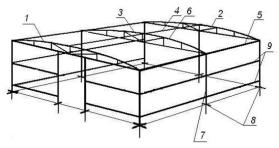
Схема каркаса группового сетчатого изолятора: 1 — ферма торцевая передняя; 2 — ферма торцевая задняя; 3 — ферма промежуточная; 4 — коньковые брусья; 5 — распорные брусья; 6 — верхняя часть фермы; 7 — стойка; 8 — направляющий штырь опоры; 9 — брусья
